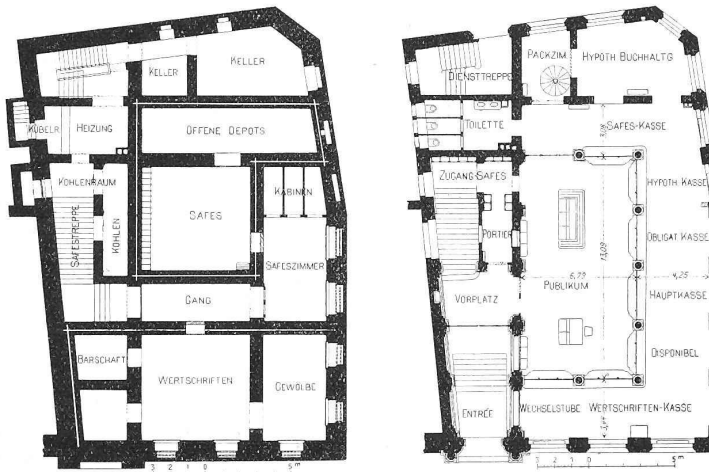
Grundriss vom Kellergeschoss. — 1:400 — Abb. 3. Grundriss vom Erdgeschoss.
